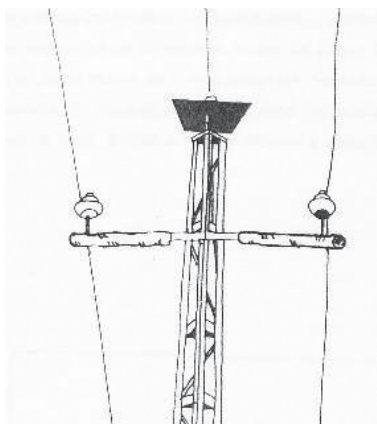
Tubos de PVC en travesaño y placa bajo fase central
